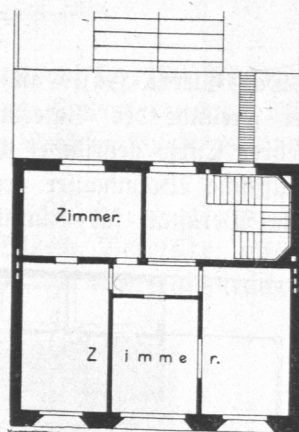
Volksheim Sachsenstraße, 2. Obergeschoß, Grundriß.
